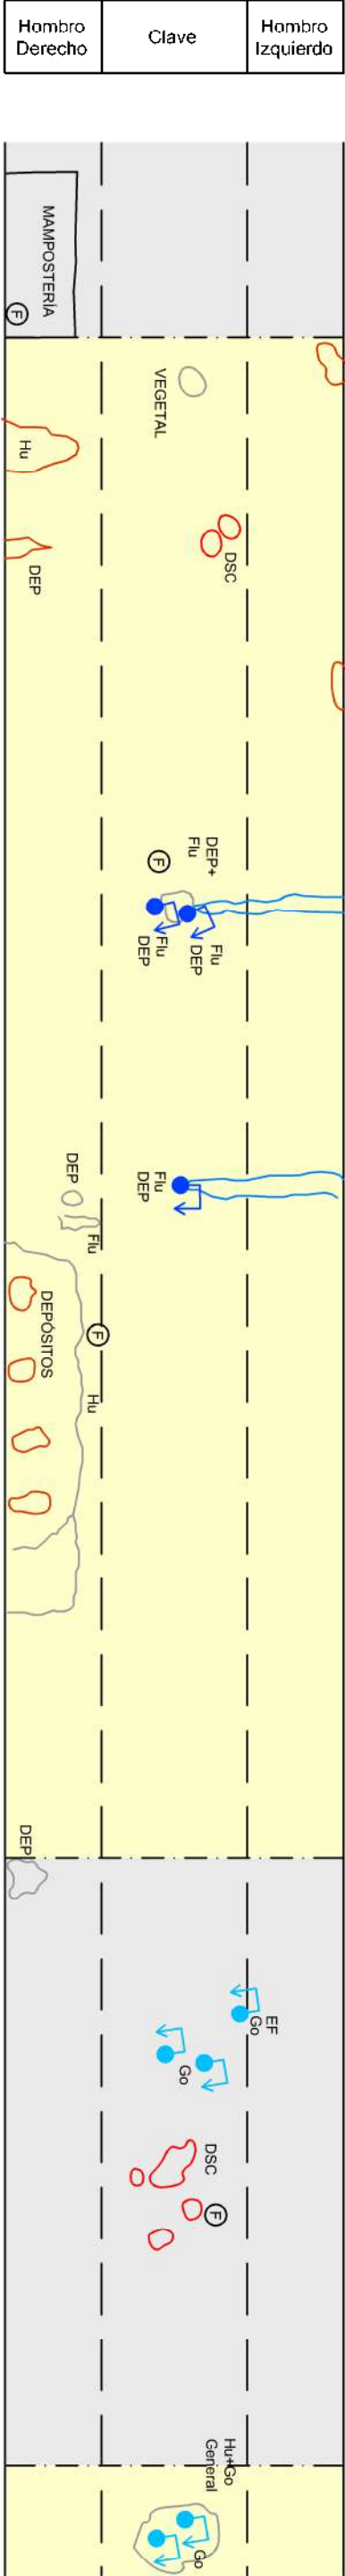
PLANTA LEVANTAMIENTO PATOLOGÍAS
